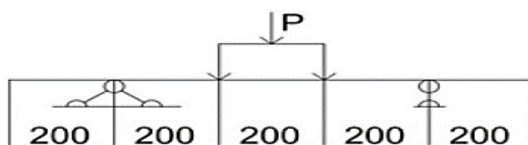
Схема нагружения модельных железобетонных плит перекрытия
